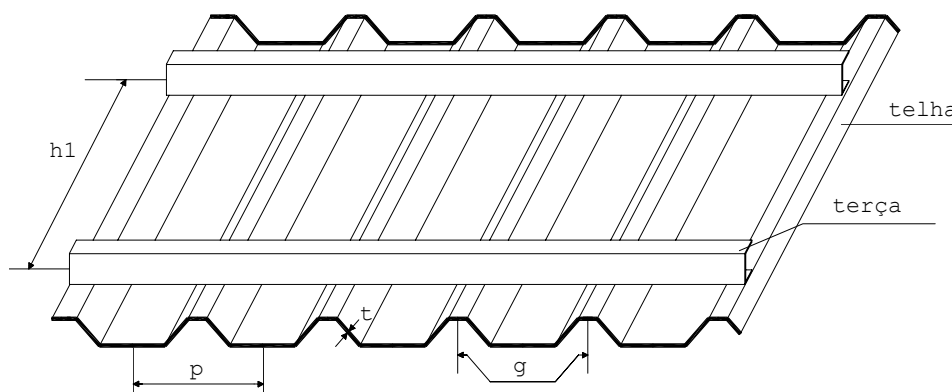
Seção trapezoidal (Modificado de YU 1985)
